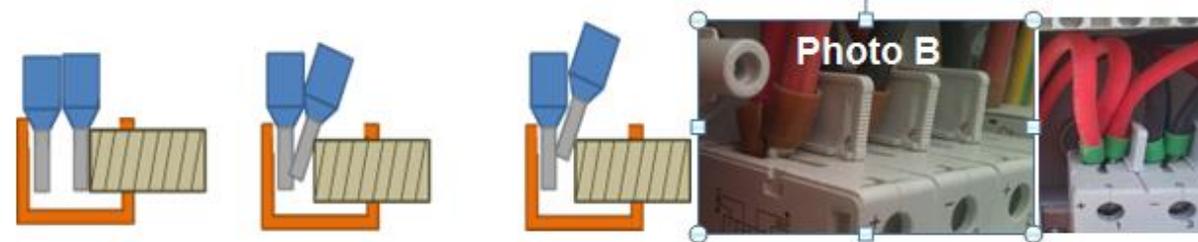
DEFAT DE SERRAGE LIE AUX EMBOUTS DE CABLAGE
